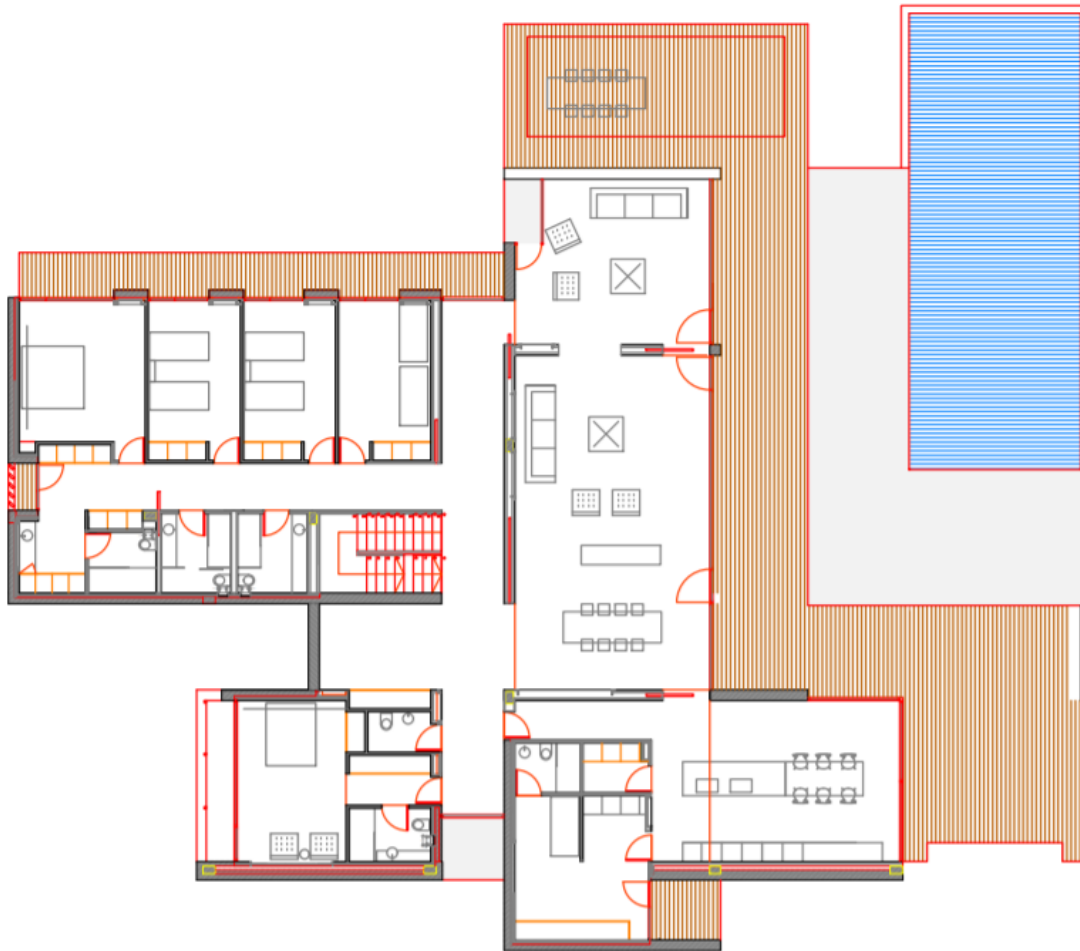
Elaboración propia. Plano de distribución de la planta baja de la vivienda.
